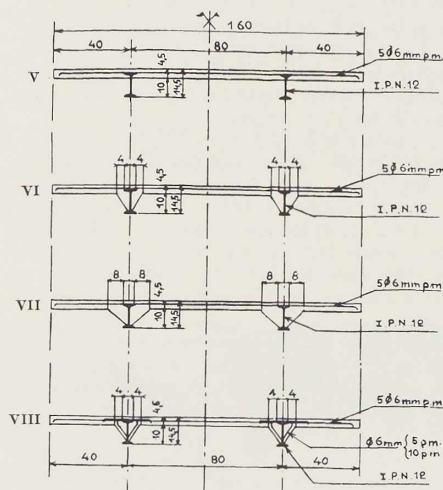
Les solives de hourdis V à VIII sont des poutrelles P.N. 12 : ces poutrelles sont engagées de 2 cm dans l'épaisseur de la dalle en béton armé. La hauteur totale des 8 éléments est de 14,5 cm. Toutes les dalles ont 4,5 cm de hauteur.
